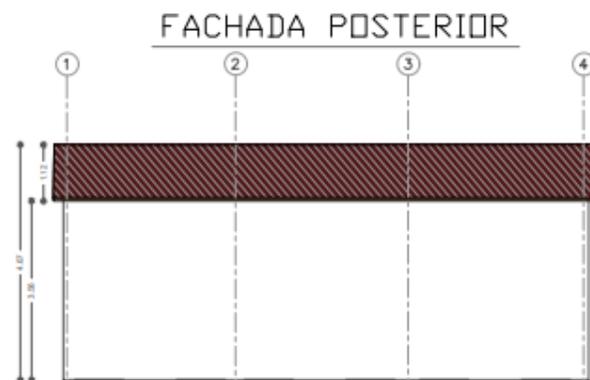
FACHADA POSTERIOR DEL DEPOSITO 5. PLANTA CARIONGO. EXITENTES EN LA ACTUALIDAD
